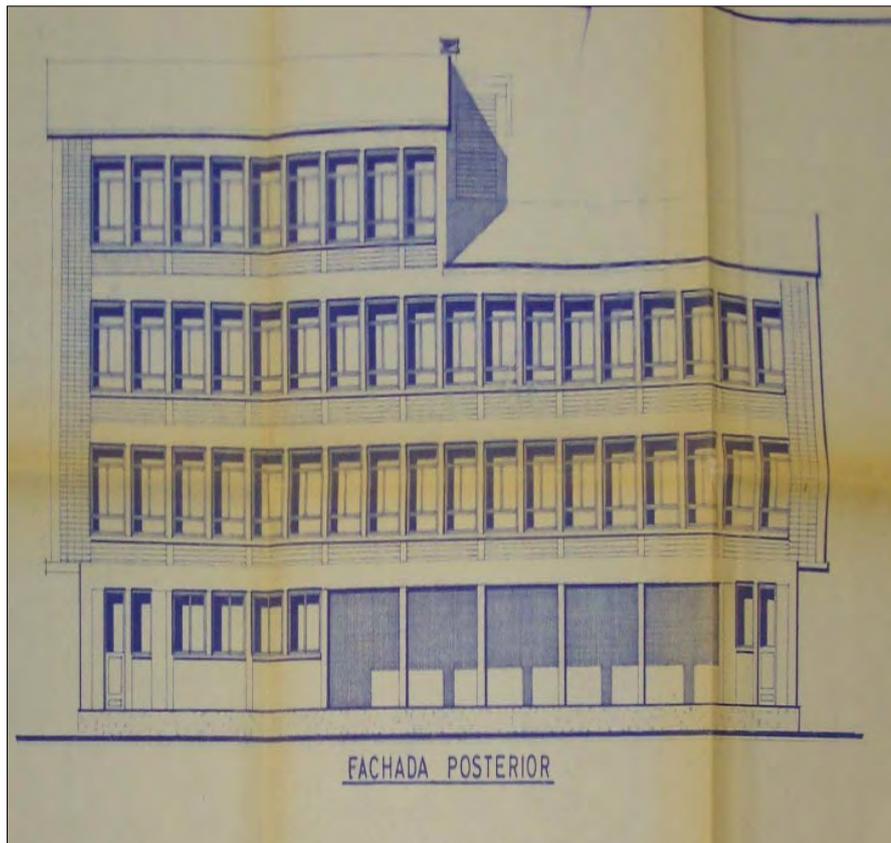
Ídem. Alzado posterior<sup>377</sup>
